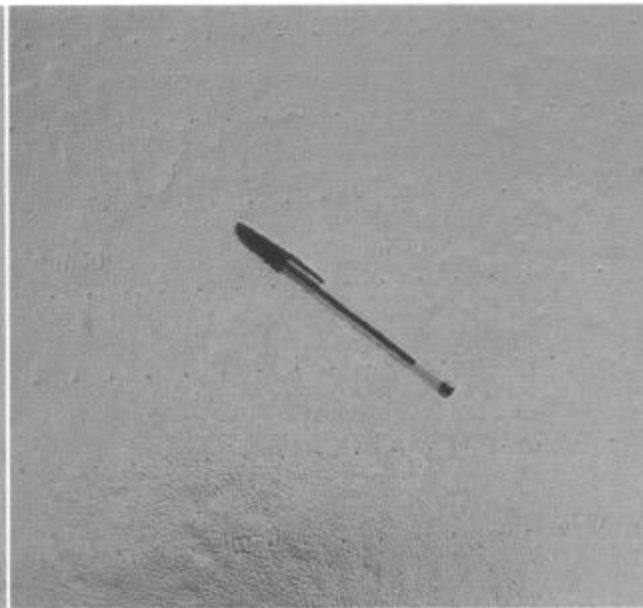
Trecho da face da placa – face oposta à da incidência sonora.
